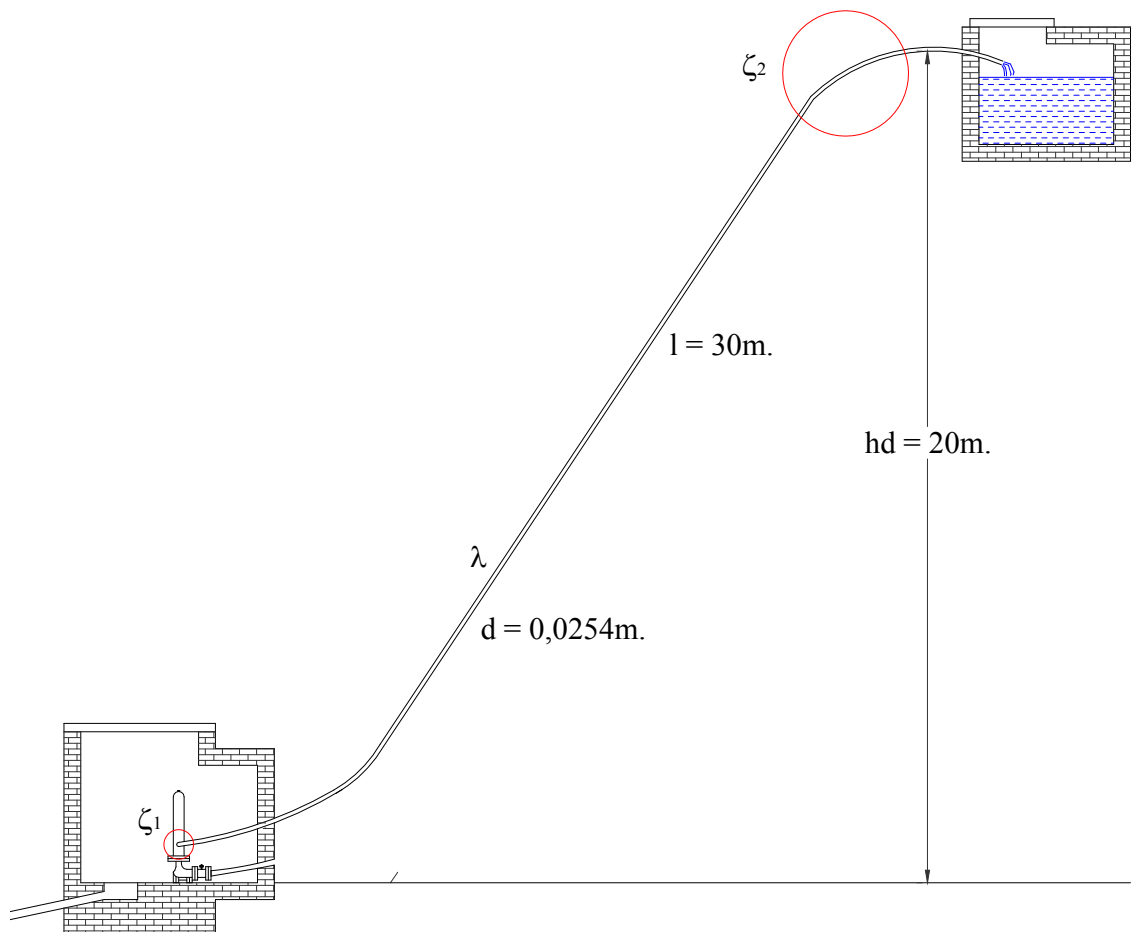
Pérdidas locales en la tubería de descarga.
